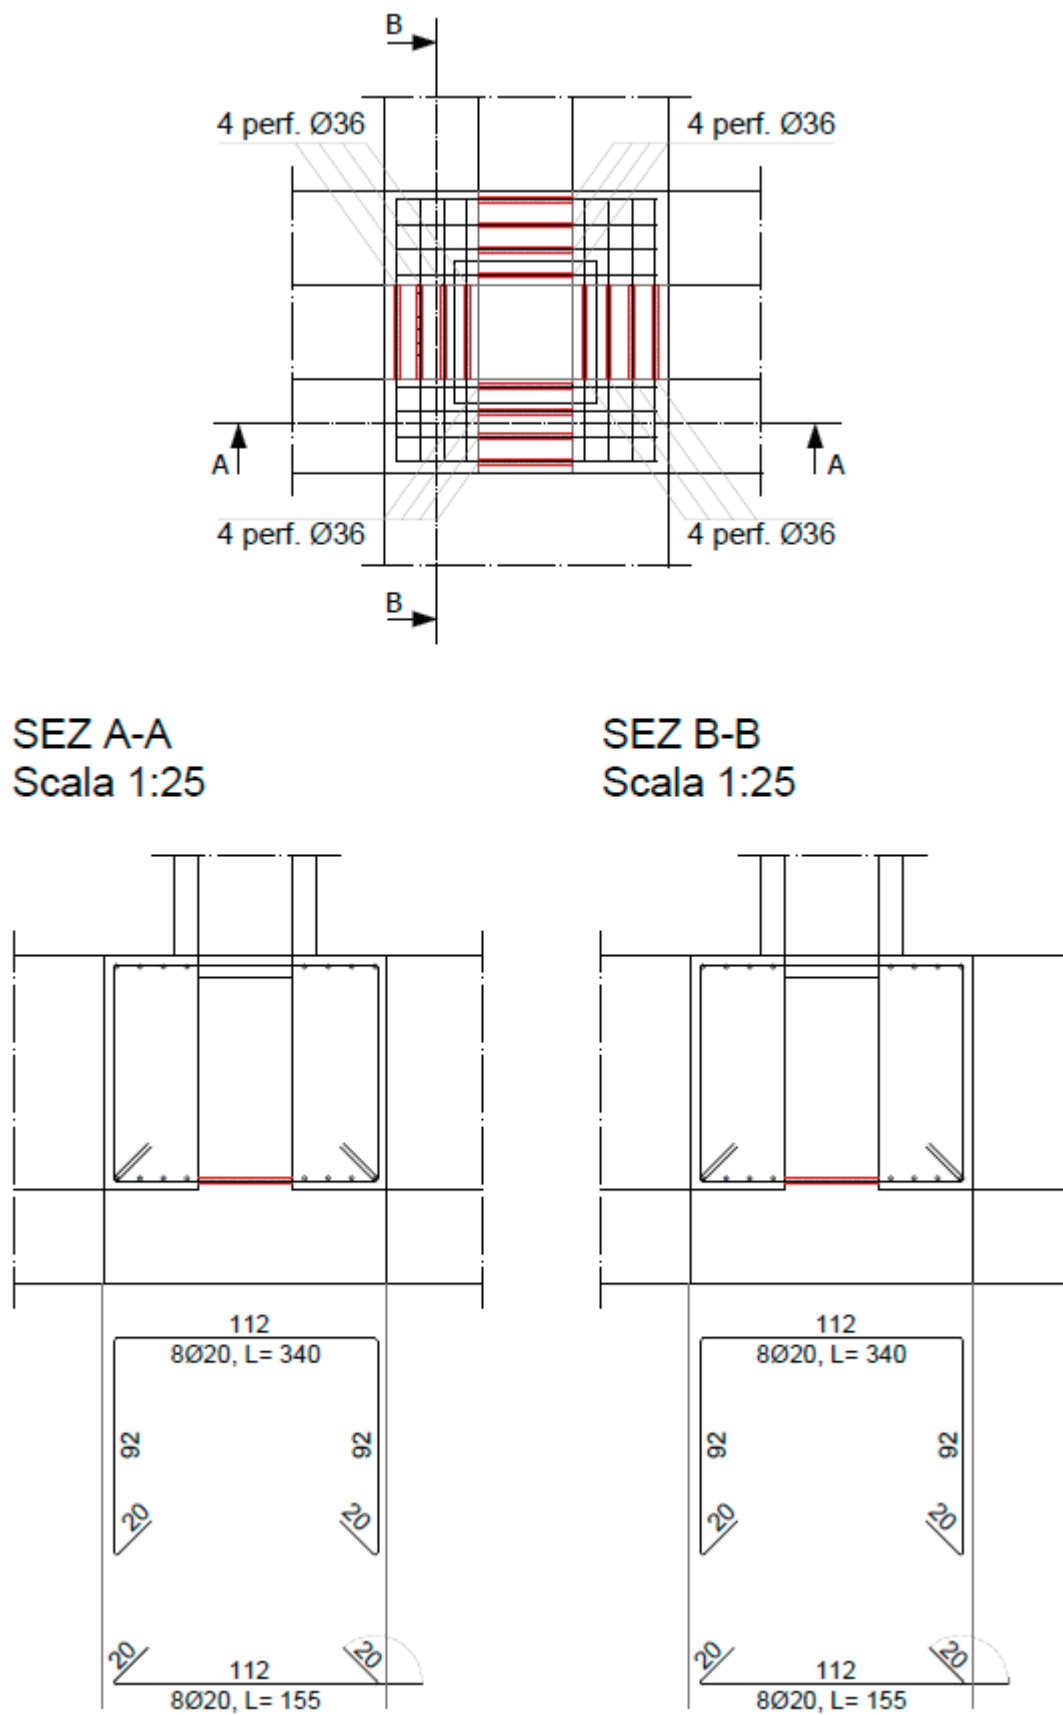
Intervento in fondazione – Plinti in corrispondenza dei pilastri ringrossati
